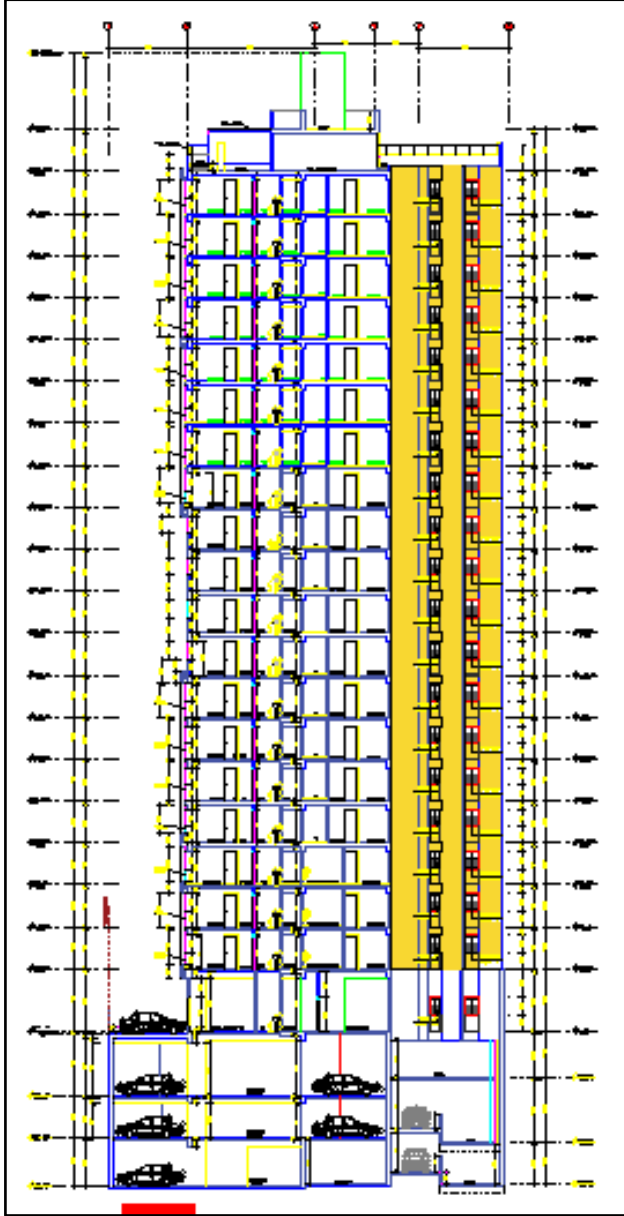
Sectorización de las fachadas interior y exterior en plano de *AutoCAD*.
